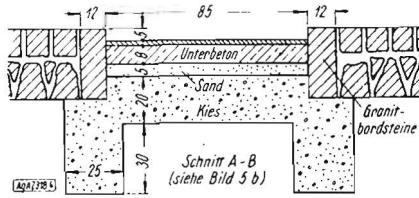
Schnitt durch die Schleppbahn außerhalb des Stalles
